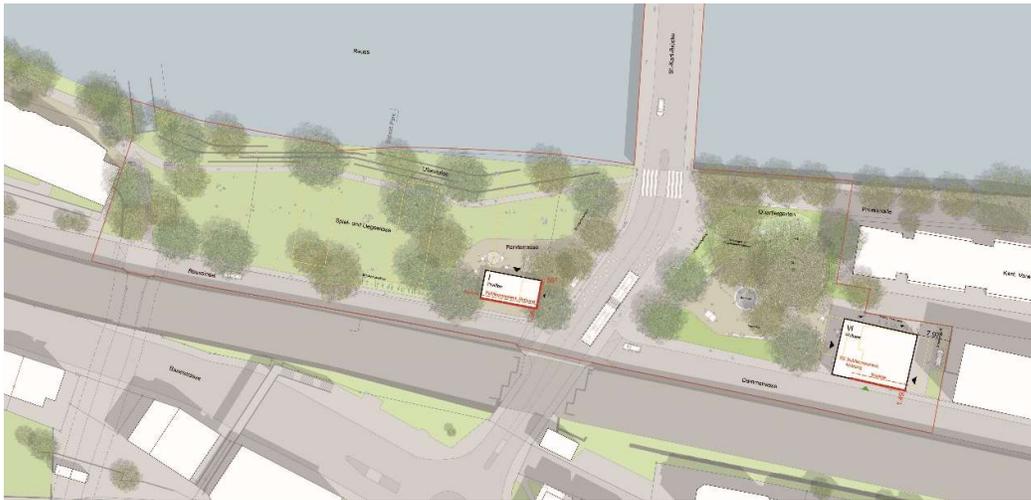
Ausschnitt Situationsplan Variante «Reusspark plus Dammgärtli»
